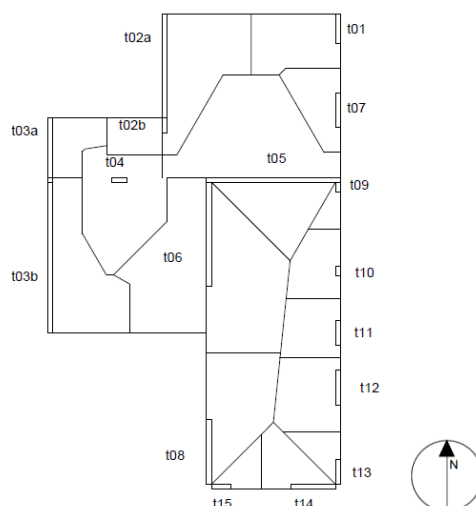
Divisão de trechos de paredes para carregamento sobre fundações
